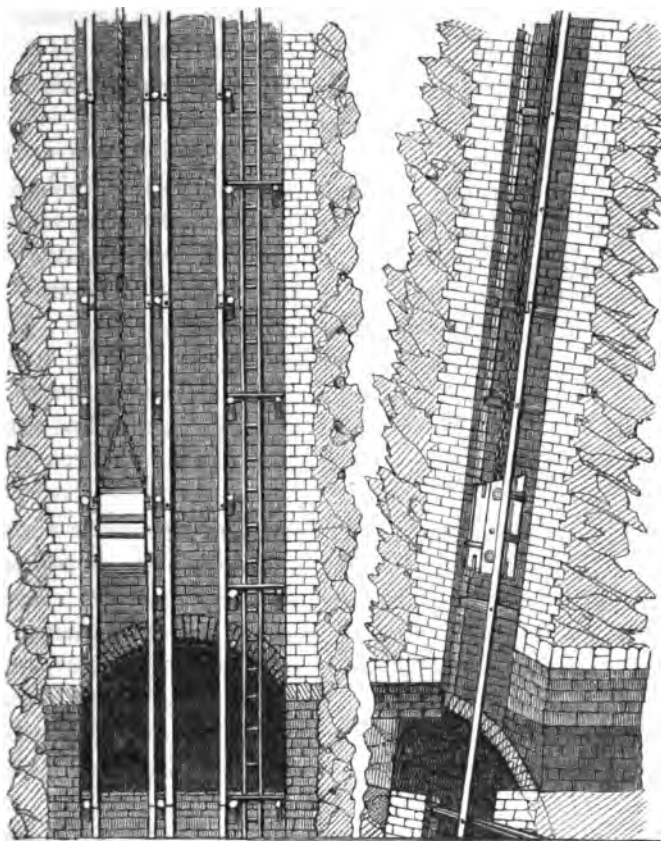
Coupes d'un puits incliné murailé, au flors.
